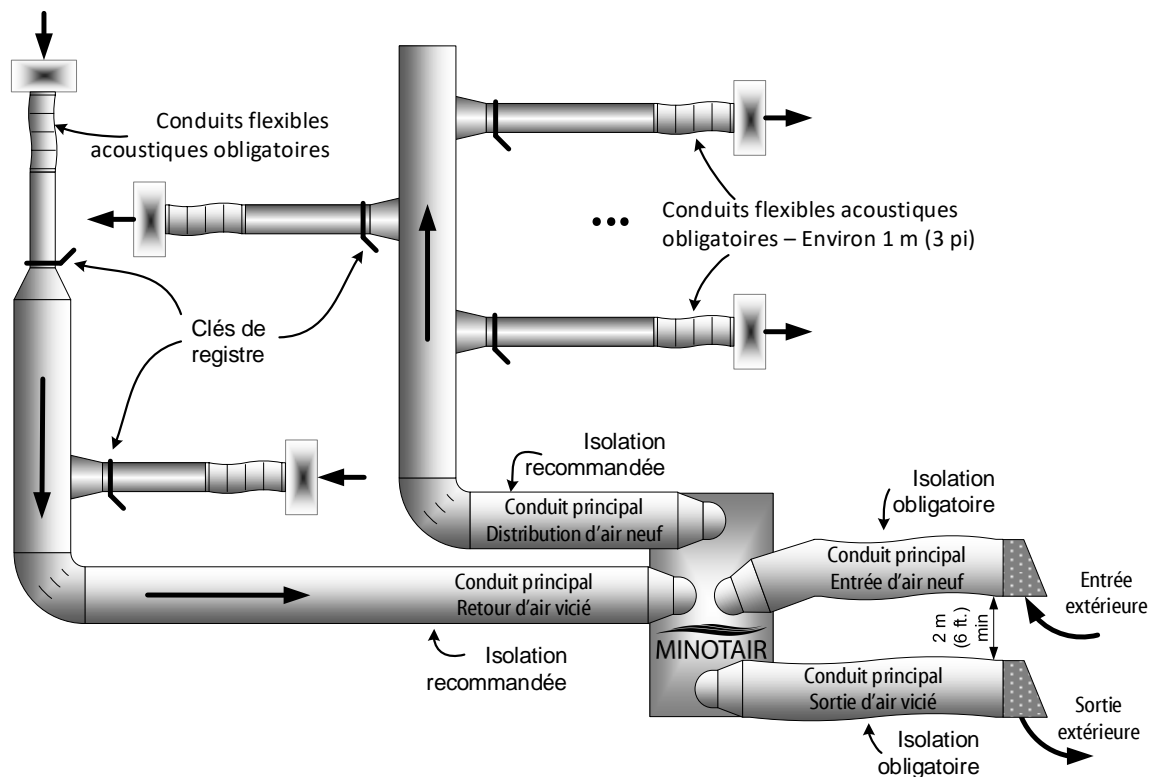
Branchement à un système de conduits de ventilation indépendant.
